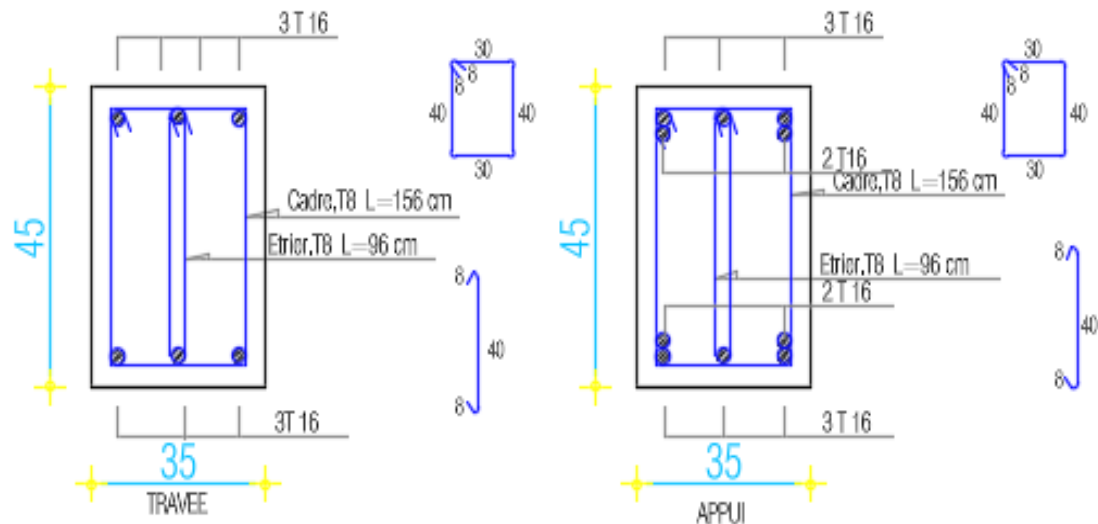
Schéma de ferraillage de la poutre no porteur sur travée et appuis.
